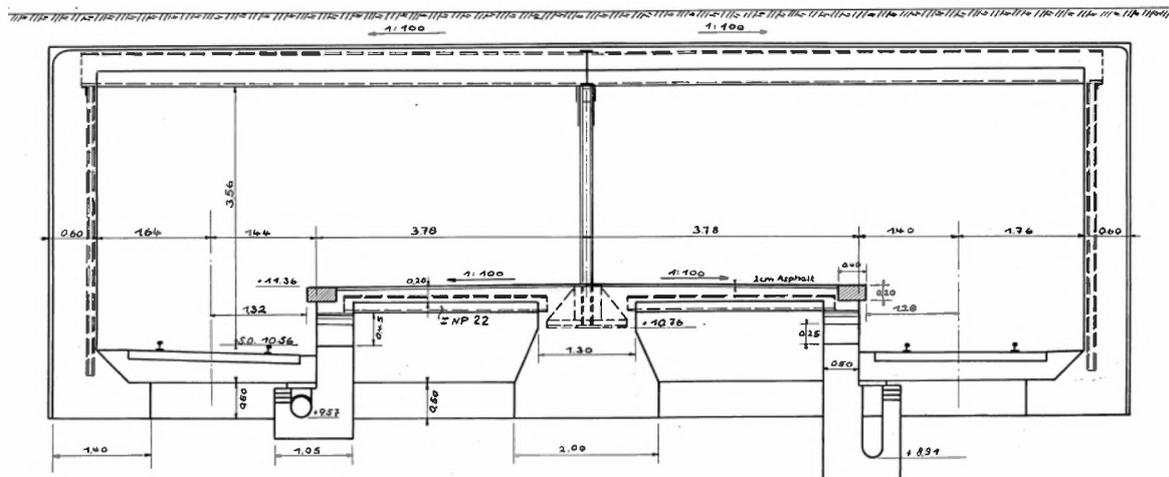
U-Bahn-Station Sternschanze, Bestandsplan [U26]
